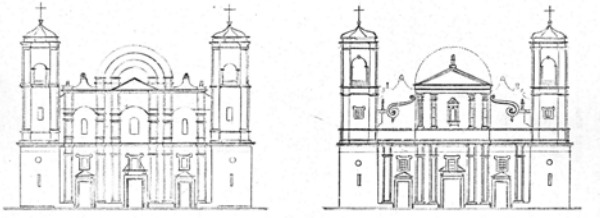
Izquierda: Catedral de Zipaquirá antes de su restauración; Derecha: Catedral de Zipaquirá - proyecto de restauración.
